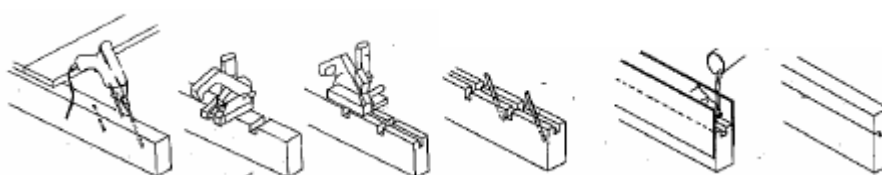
Aumento da inércia de vigas de madeira com recurso a argamassa de epóxido.
